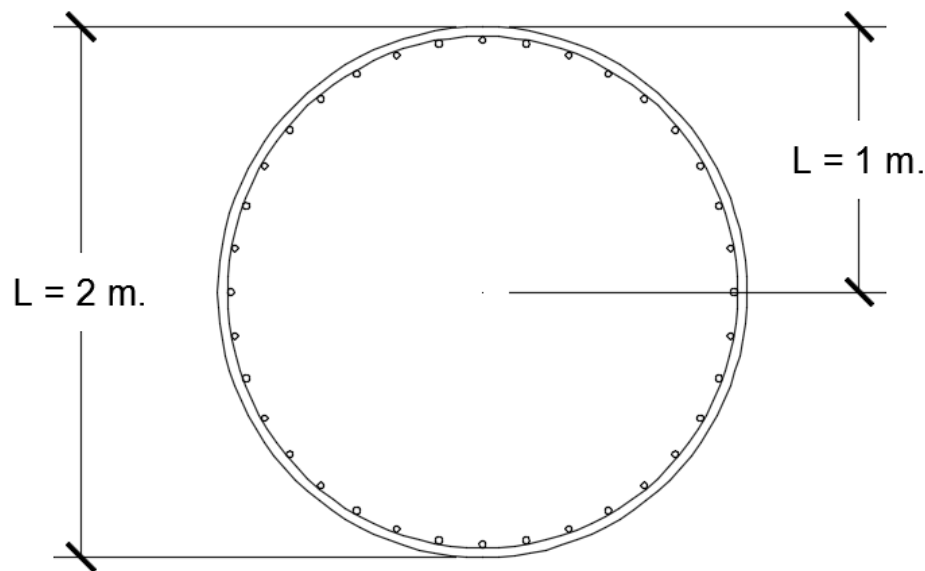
Sección y distribución final de acero para pilar en 1 y 3 (Fuente: elaboración propia)
